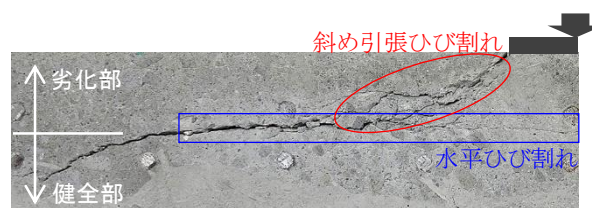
斜め引張ひび割れと水平ひび割れ (F-H/2)
